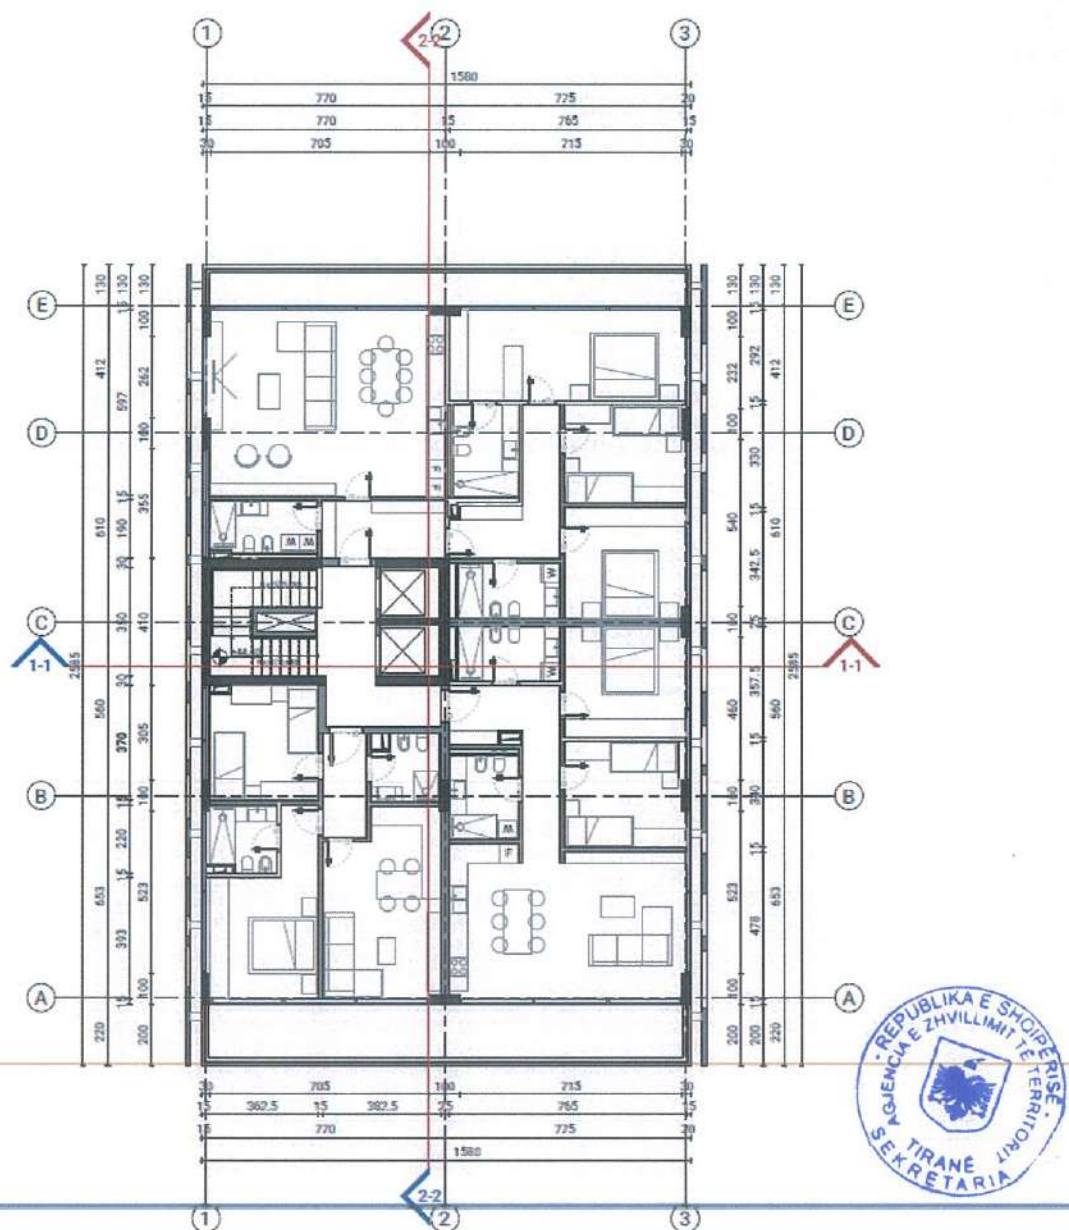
Planimetria e katit Tip, Kati 12 - Kati 13
